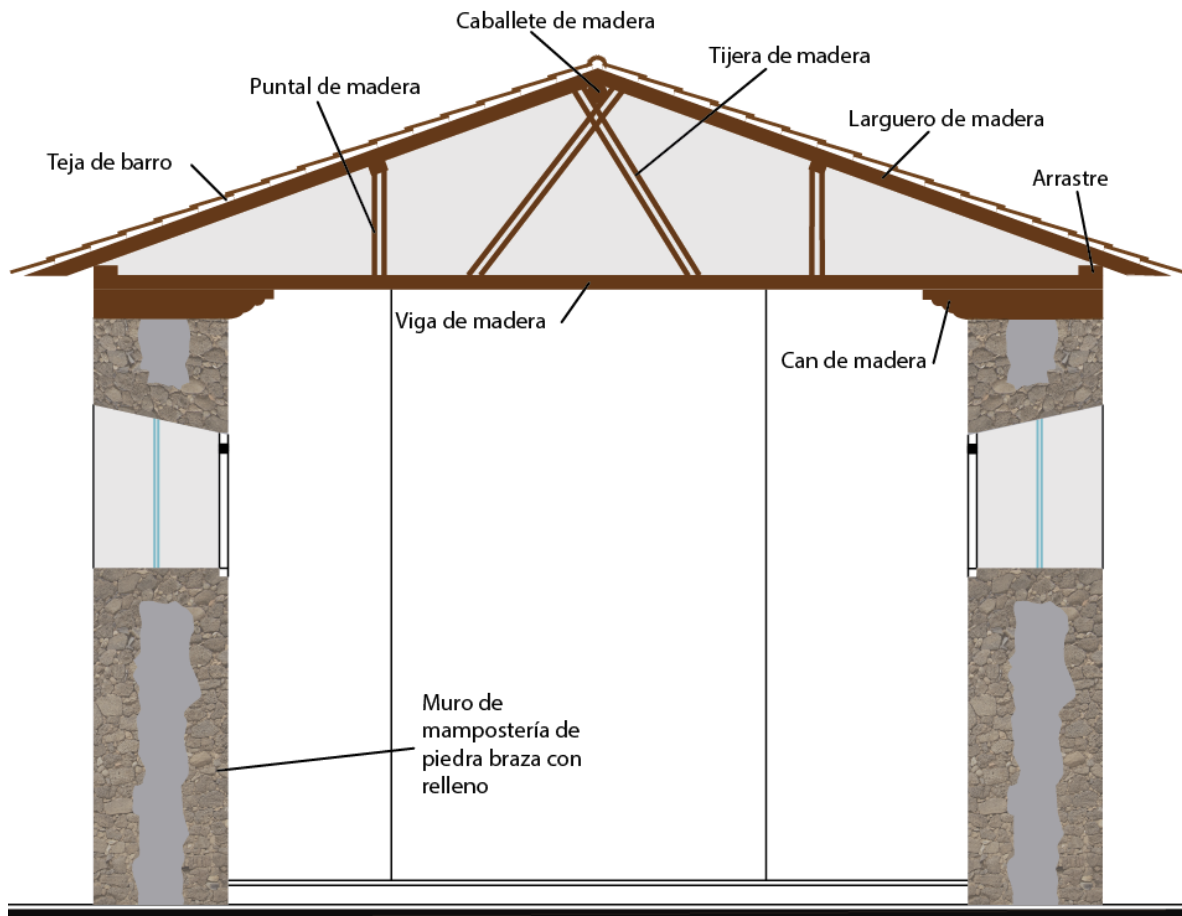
Corte de la nave para ver sistema constructivo. Elaboración propia.
